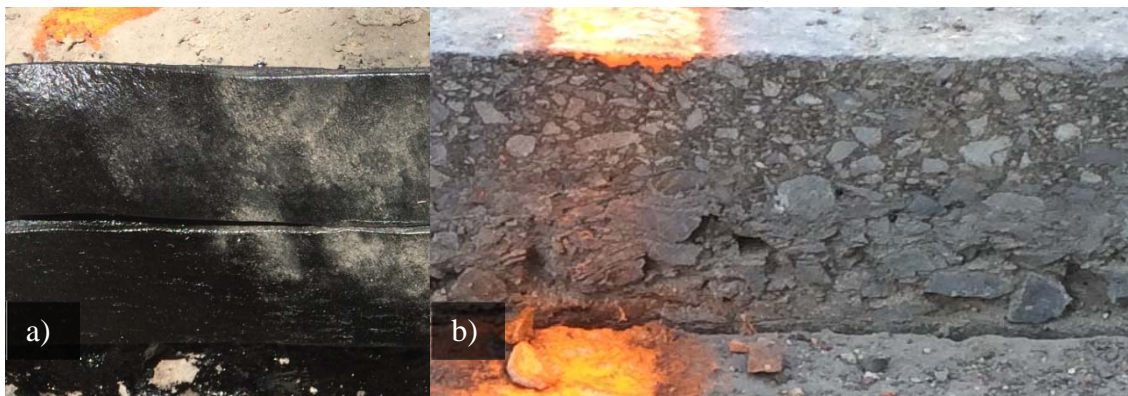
a) Installation de 2 bandes bitumineuses de haut sur une coupe dans la chaussée et b) Détail de la chaussée du chantier #1, 50 mm d'enrobé sur 50 mm remblai sans retrait (échec)
